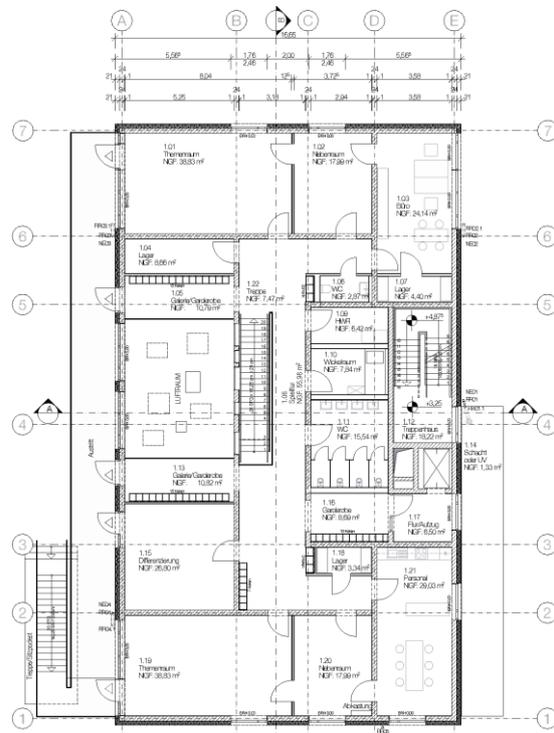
Grundriss I. OG _ Kita_HWR
